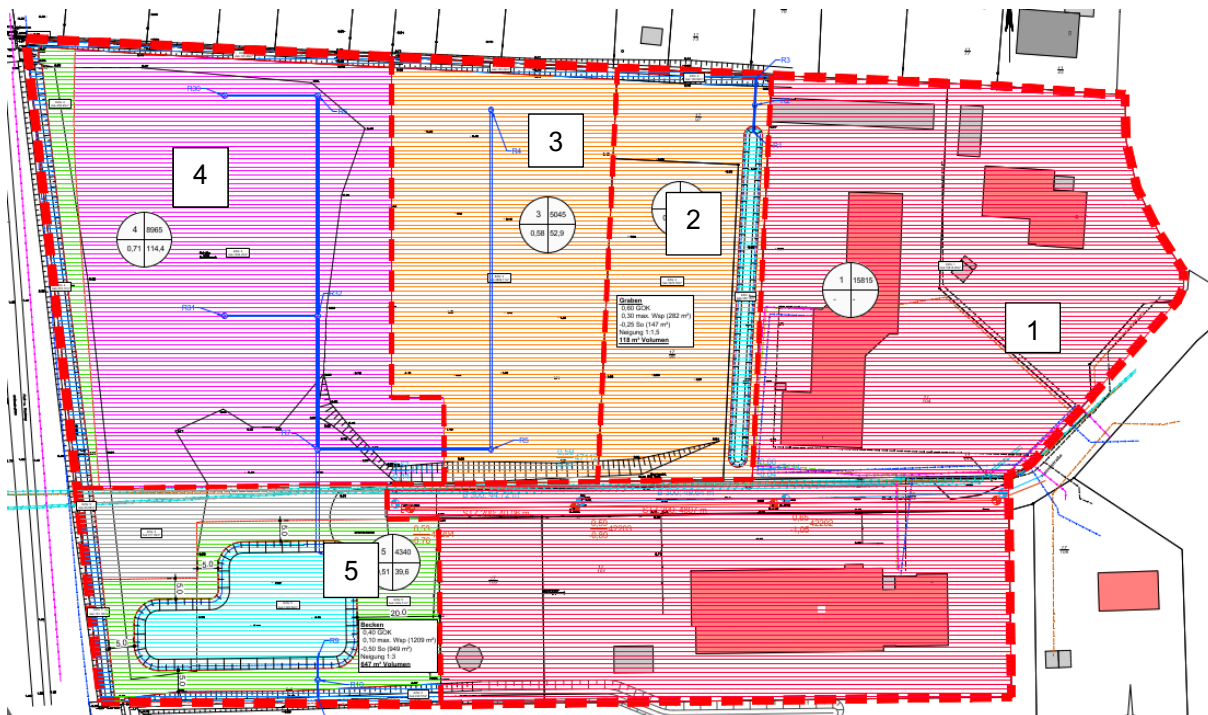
Lageplan aus dem Oberflächenentwässerungskonzept
